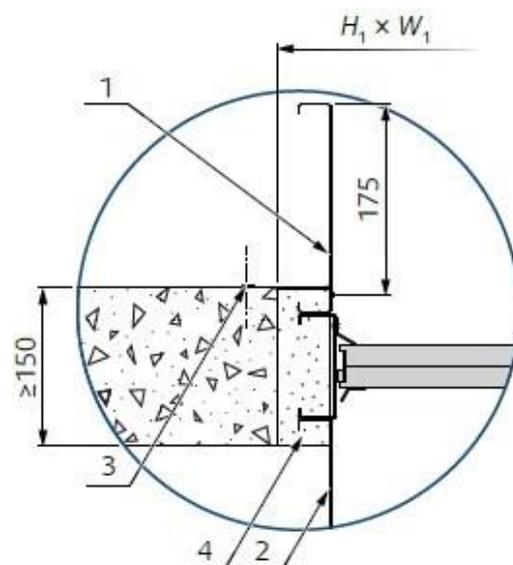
(EI120S) Sezione trasversale per installazione a umido in pavimenti/solette rigidi (attuatore sopra)
